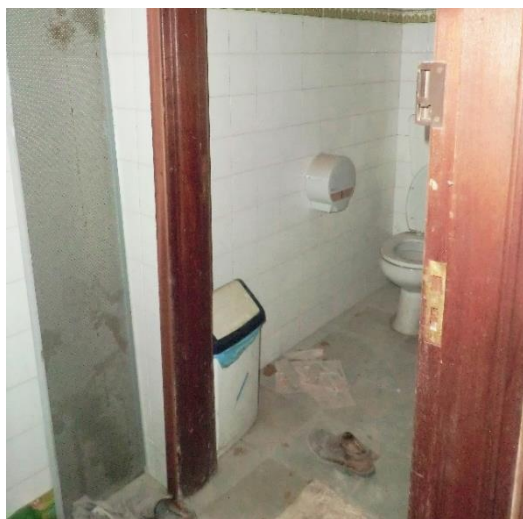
Patologias verificadas ao nível das paredes e pavimento
